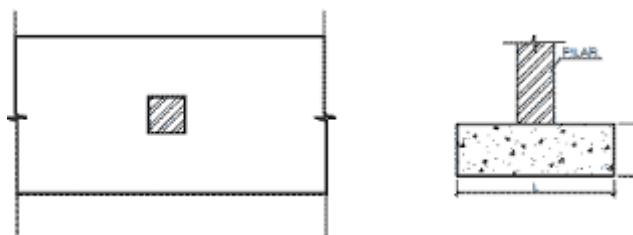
Representação em planta e corte de uma sapata contínua de suporte a um pilar
